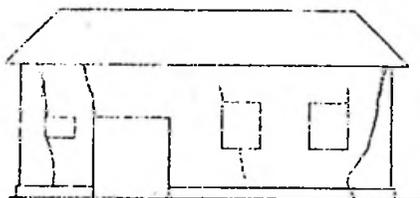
Fissuramento produzido pela expansão horizontal da argila
